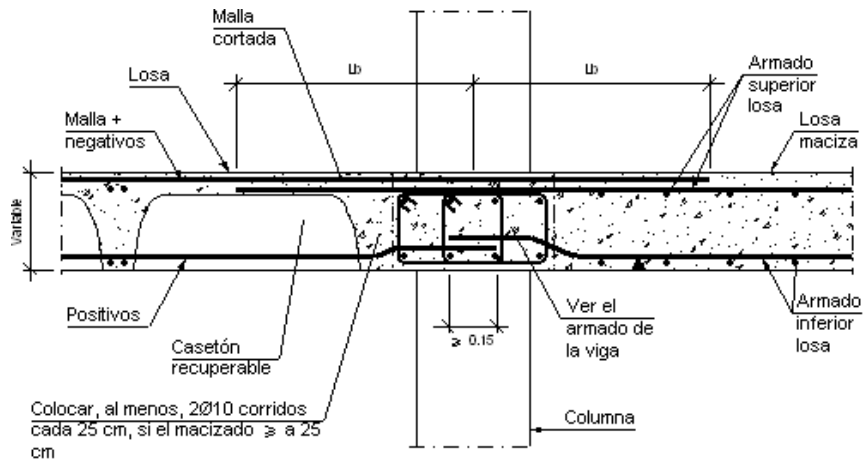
Detalle de la losa maciza Fuente: <http://detallesconstructivos-ar.ar.cype.com/EHR651.html>
